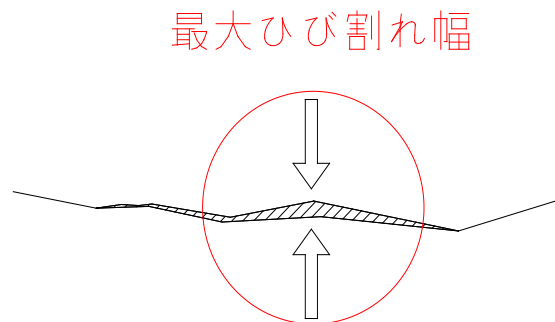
ひび割れ計測イメージ図
